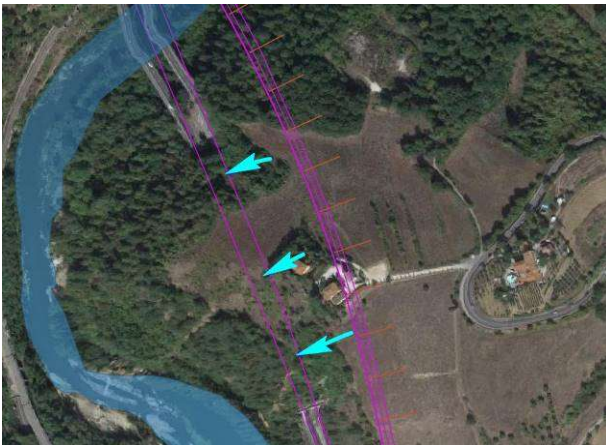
Indicazione su planimetria dei punti in cui si sono riscontrate tracce di infiltrazione nella galleria Bruschetto esistente.
